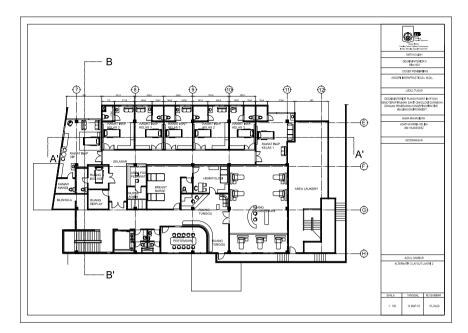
Denah Layout Lantai 1 Alternatif 3
